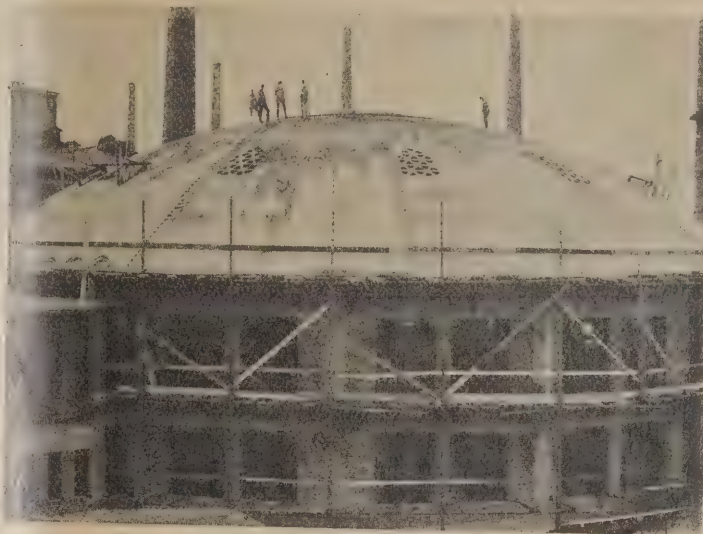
40 m weit gespannte Kuppel der Fa. Schott & Gen., Jena. Die fertig torkretierte Kuppel mit Aussparung für Sternprismen.
